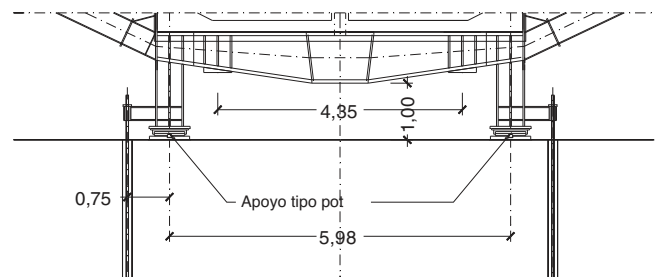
Estructura metálica de apoyo en estribos y sistema antilevantamiento.
